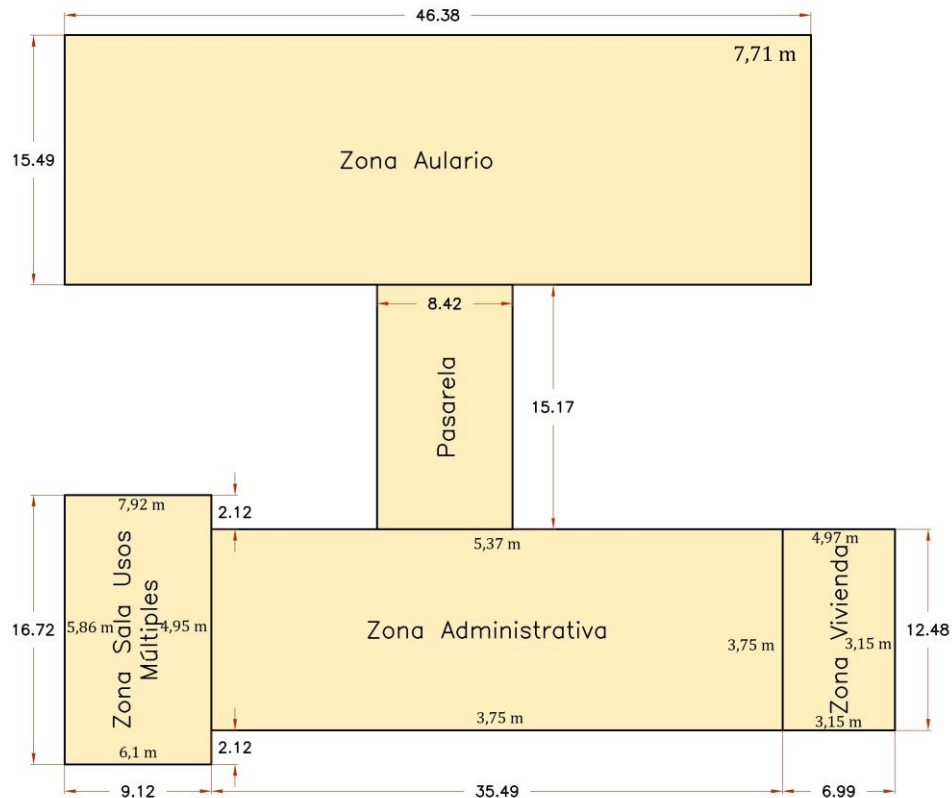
Vista en planta de la distribución por zonas del colegio acotada, orientado al norte del proyecto
